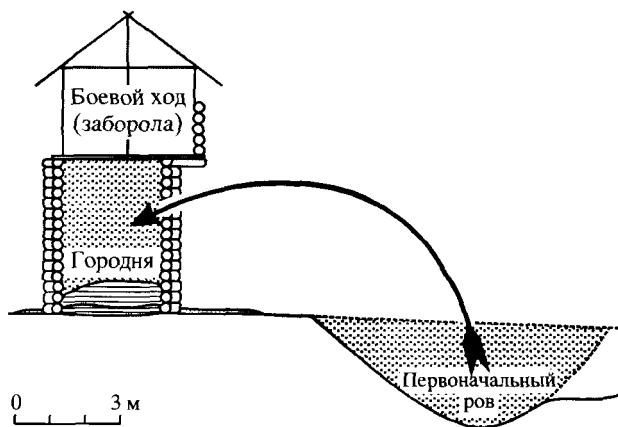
Реконструкция первоначальной стены летописного Snepрода
